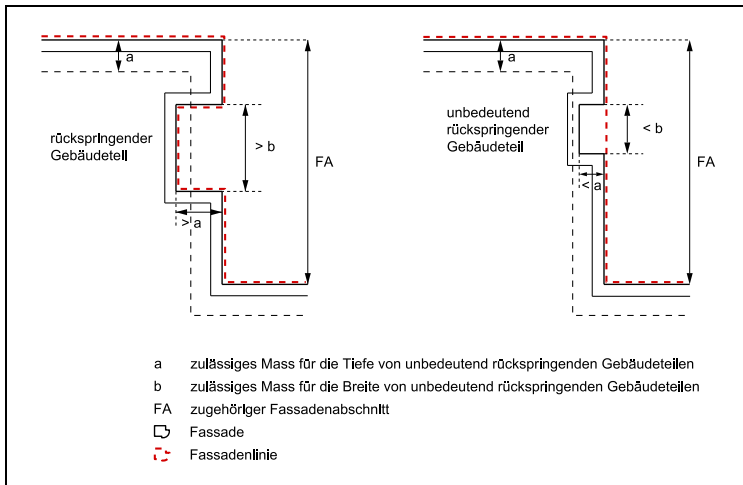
Projizierte Fassadenlinie (§ 6 b ABV)
